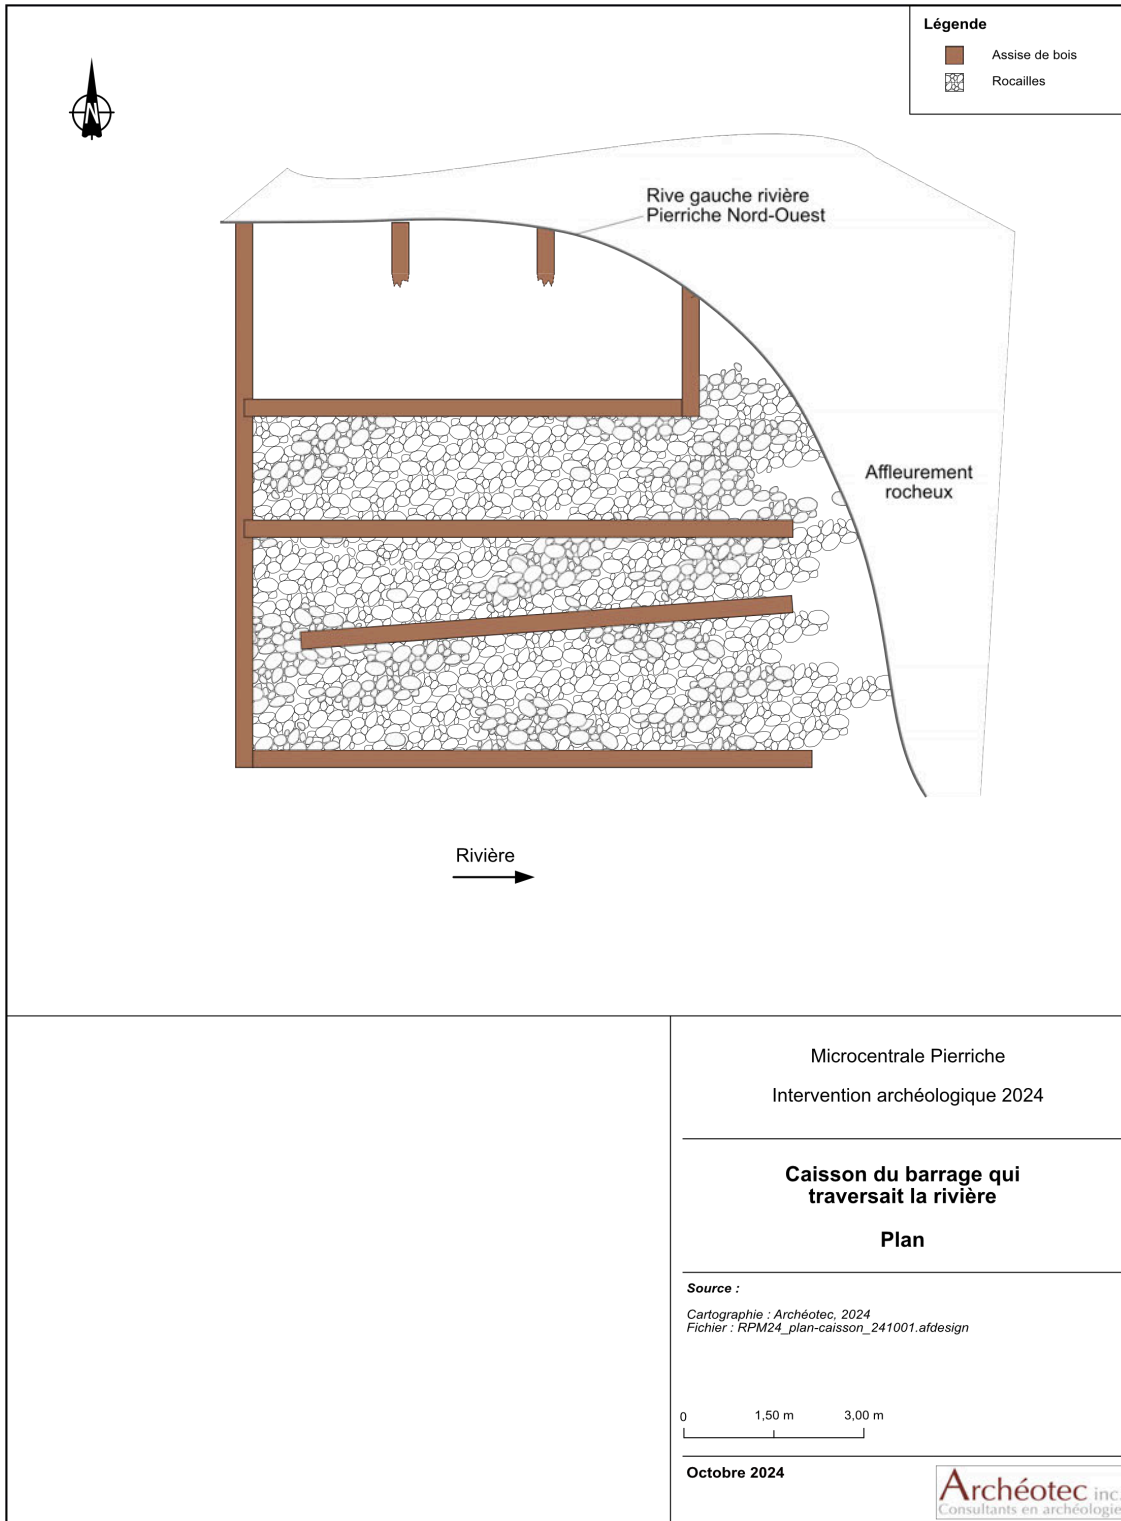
Zone A. Plan des vestiges du caisson qui s'appuyait sur la rive gauche de la Pierriche Nord-Ouest
